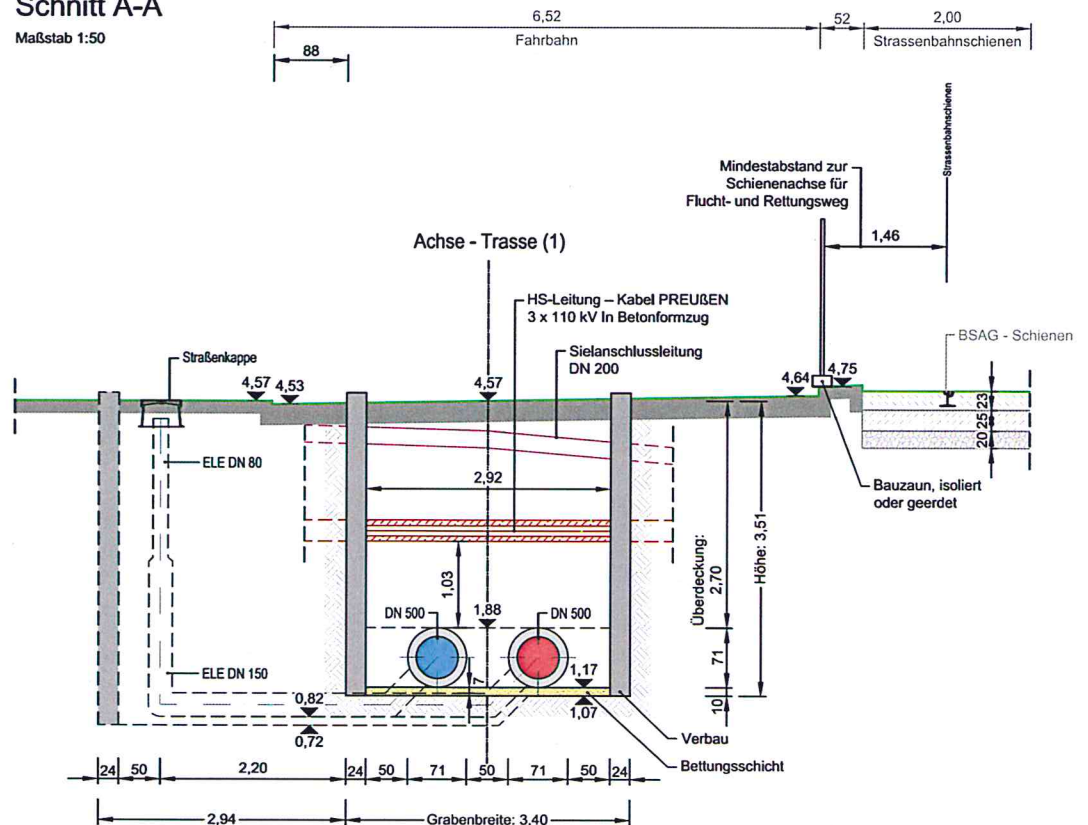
d Schnitt (24.2) Auszug aus dem Plan Nr. 4.24.2.2
